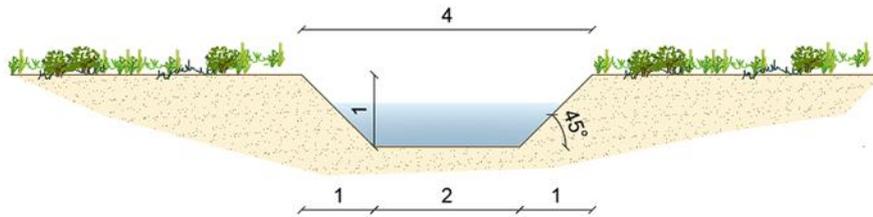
Sezione trasversale del canale in progetto "Tipo 1"
